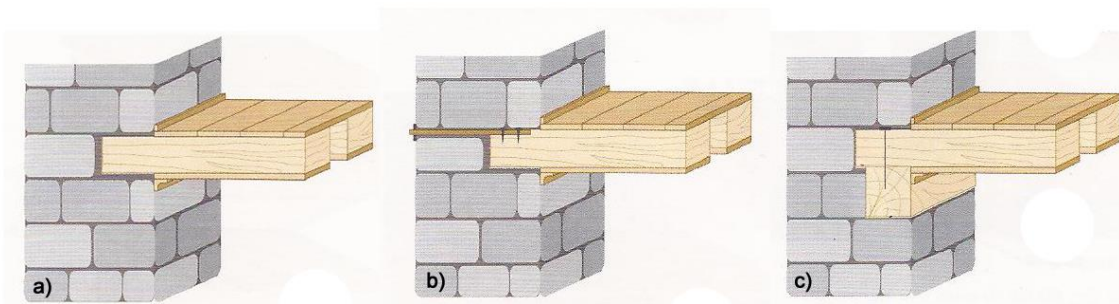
Tipos de ligações de pavimentos a paredes resistentes através de aberturas [18] (a) Ligação por encaixe; b) Ligação através de ancoragem; c) Ligação através de frechal)
